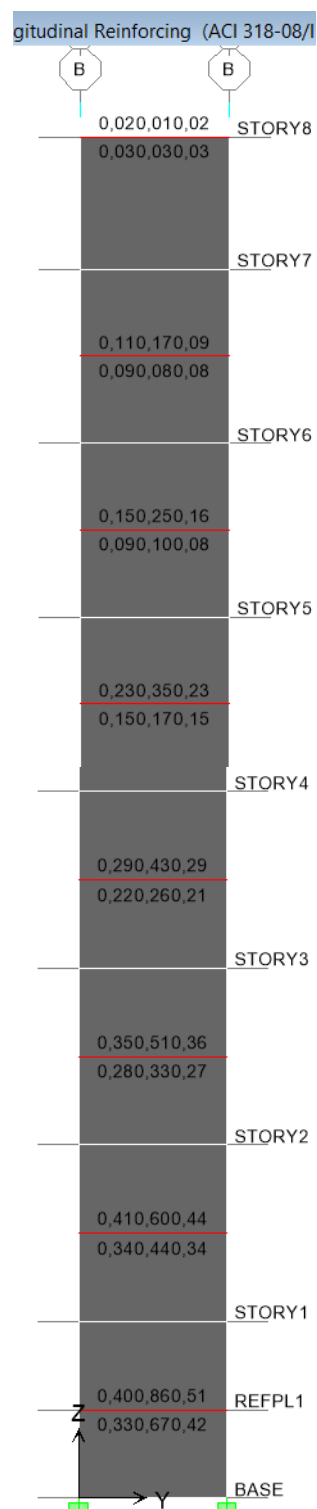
Acero en Vigas y Columnas en el Pórtico B – Escalera Emergencia Hospitalización 2- (CEC-2002)
